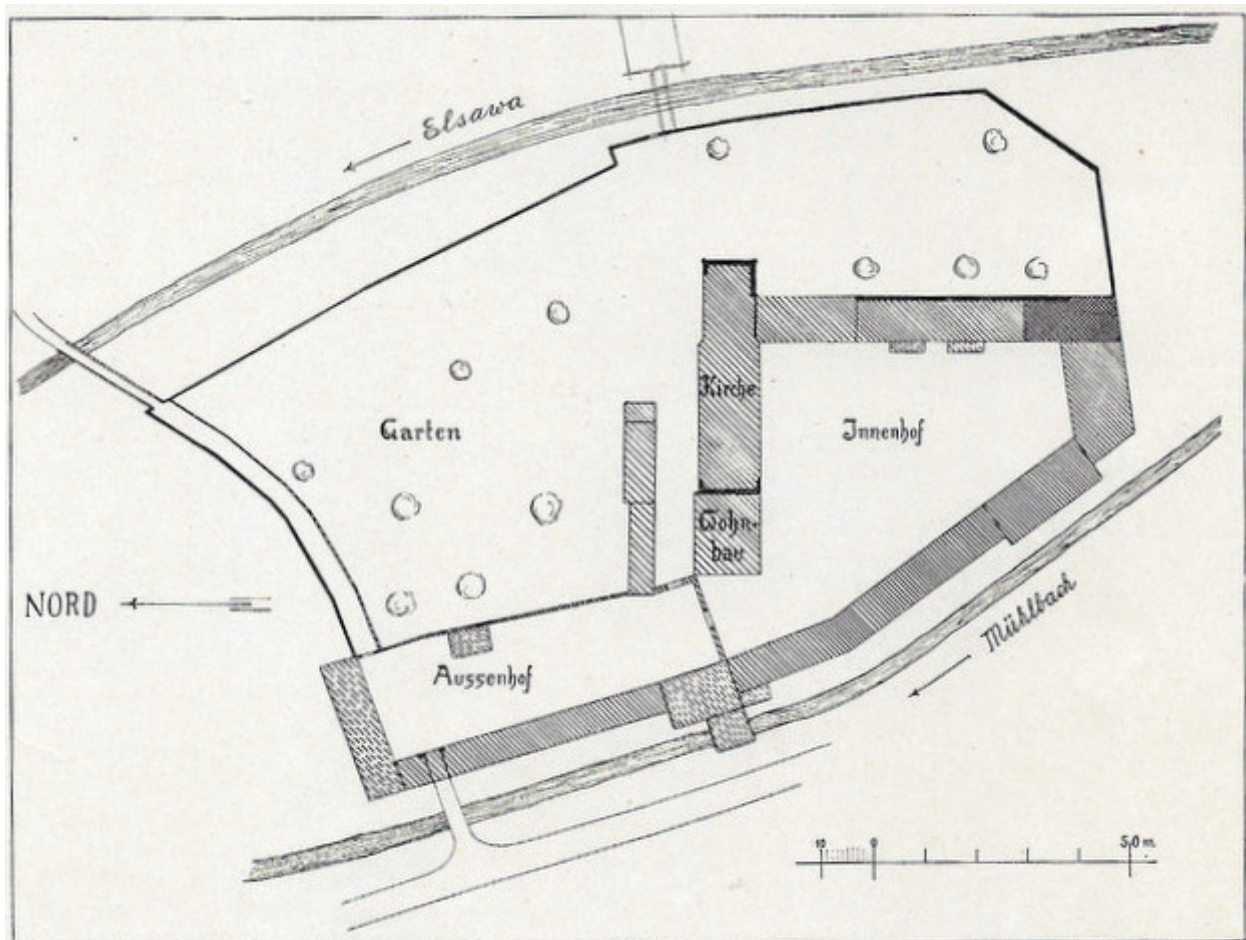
Himmelthal. Lageplan des ehem. Klosters.
